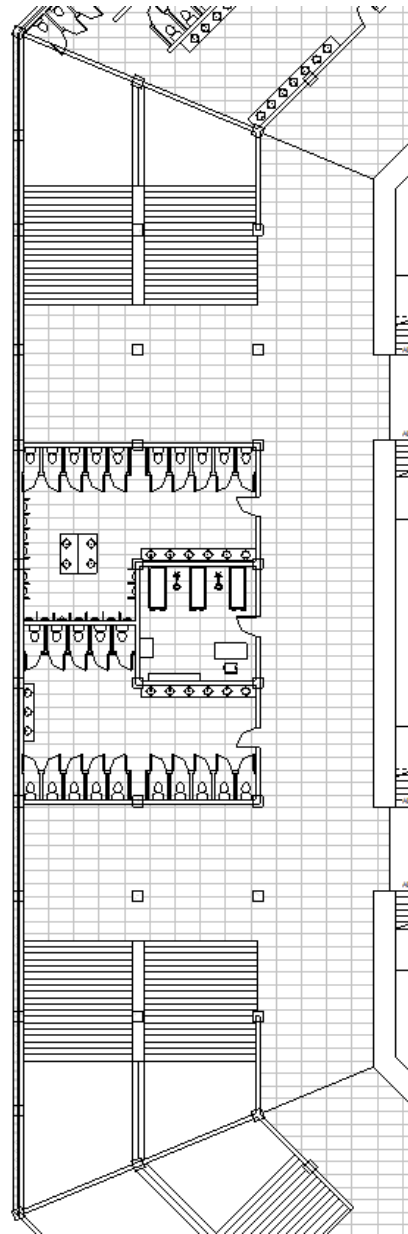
Vista en planta del sector este del primer piso. Fuente: elaboración propia.
